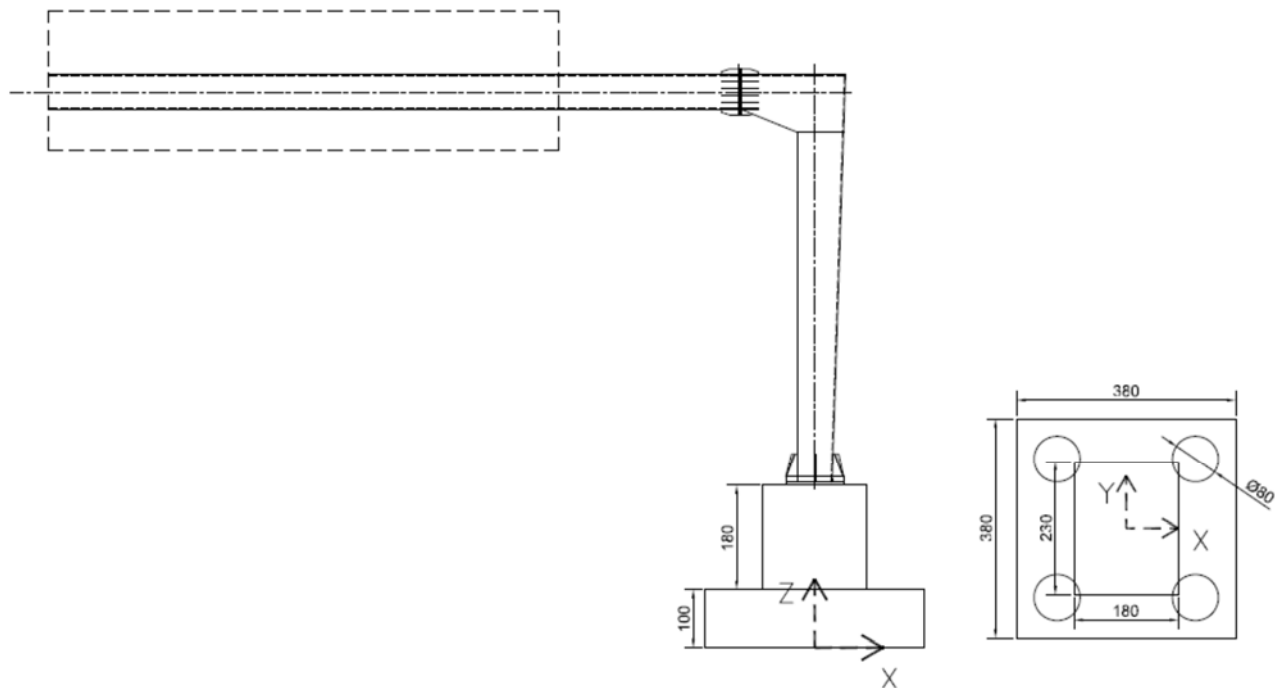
Carpenteria del plinto di fondazione - Posa su rilevato
